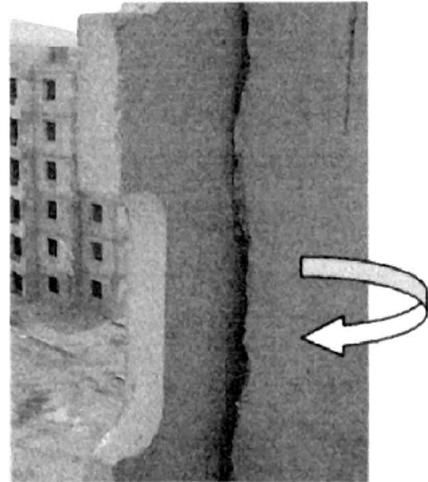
Défaut de rectitude au niveau du panneau de façade.
